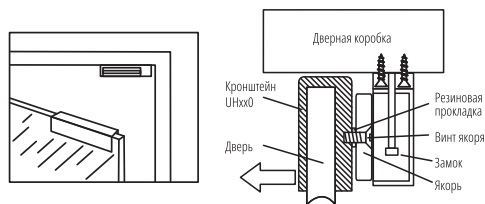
Монтаж на стеклянную дверь с помощью кронштейна U типа (UHxx0)
